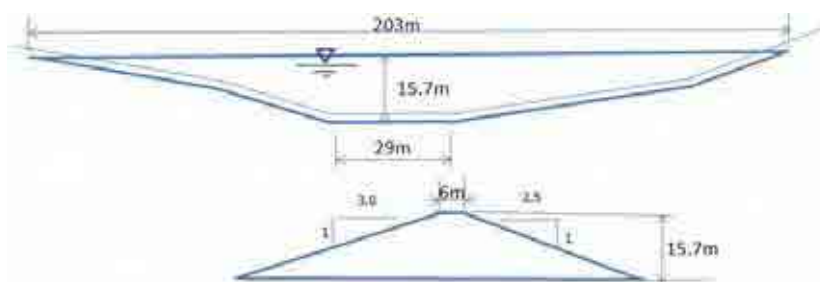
Schéma coté du corps de barrage de l'option "Barrage avec une élévation du niveau d'eau de 10 m"
